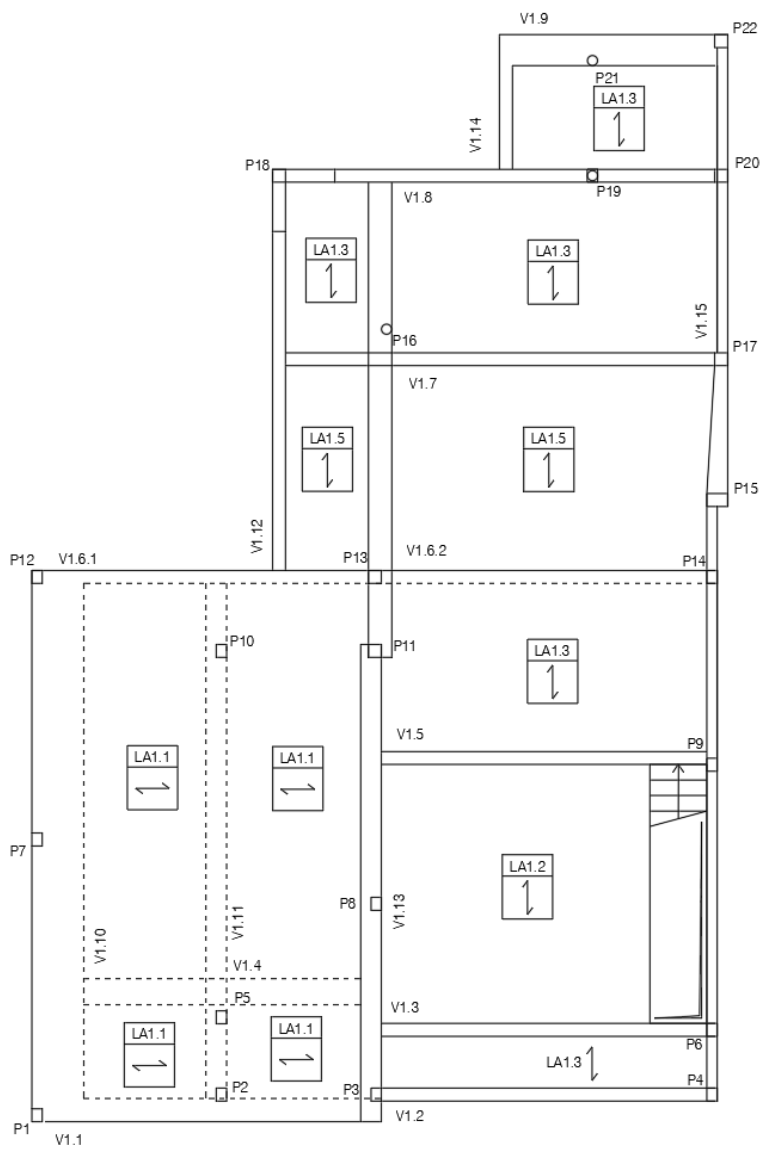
Esquema estrutural do piso elevado (Projeto de estruturas).
